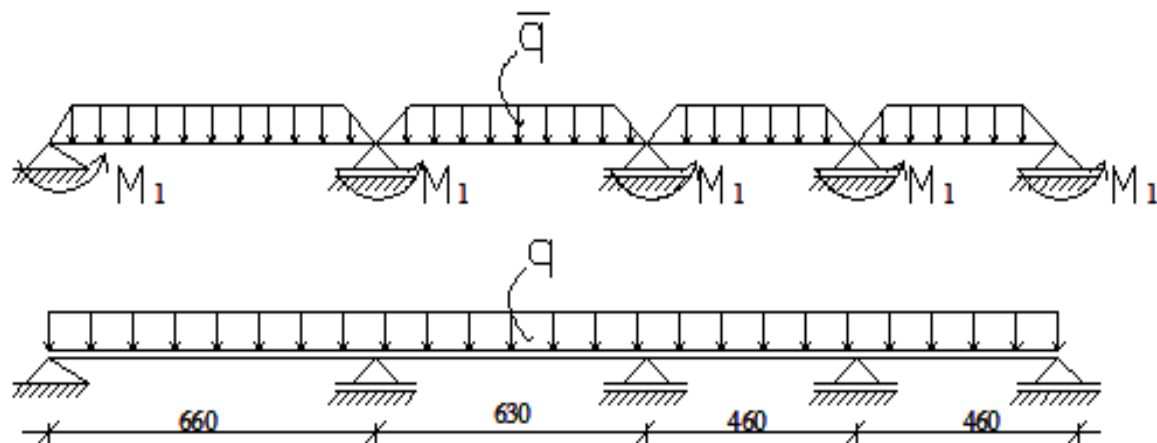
Distribution des charges sur les poutres secondaires
